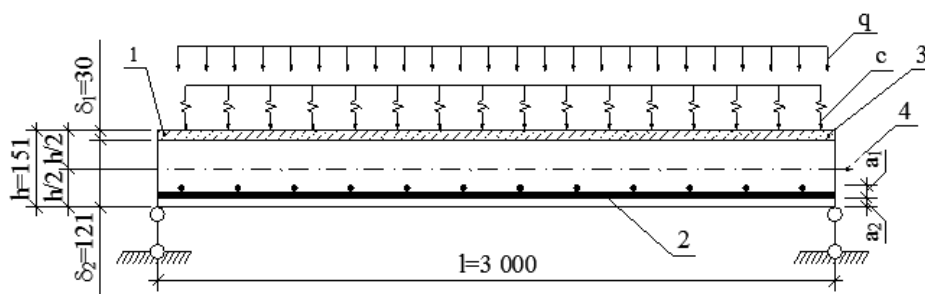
Сечение 4-4 для плиты № 4: где 1 – железобетонные слои; 2 – армированные слои; 3 – слой эпоксидного полимербетона; 4 – срединная поверхность; q – нагрузка в форме давления
